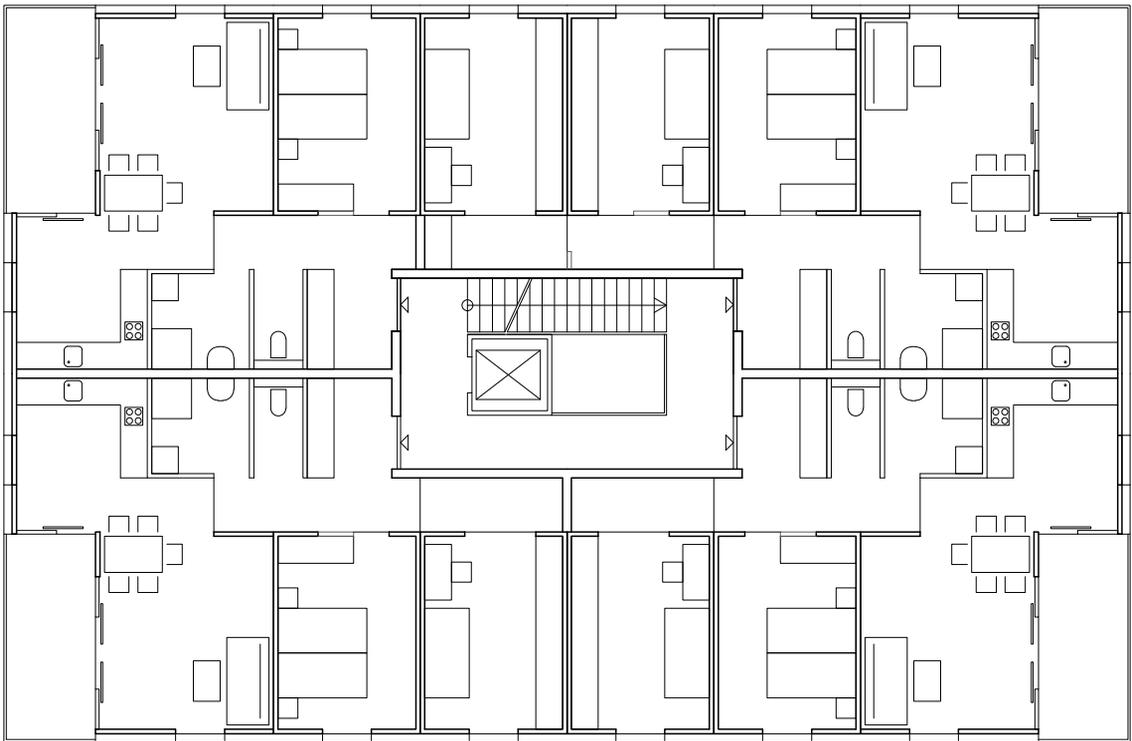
Grundriss 1.+2.OG in hybrider Raummodulbauweise
